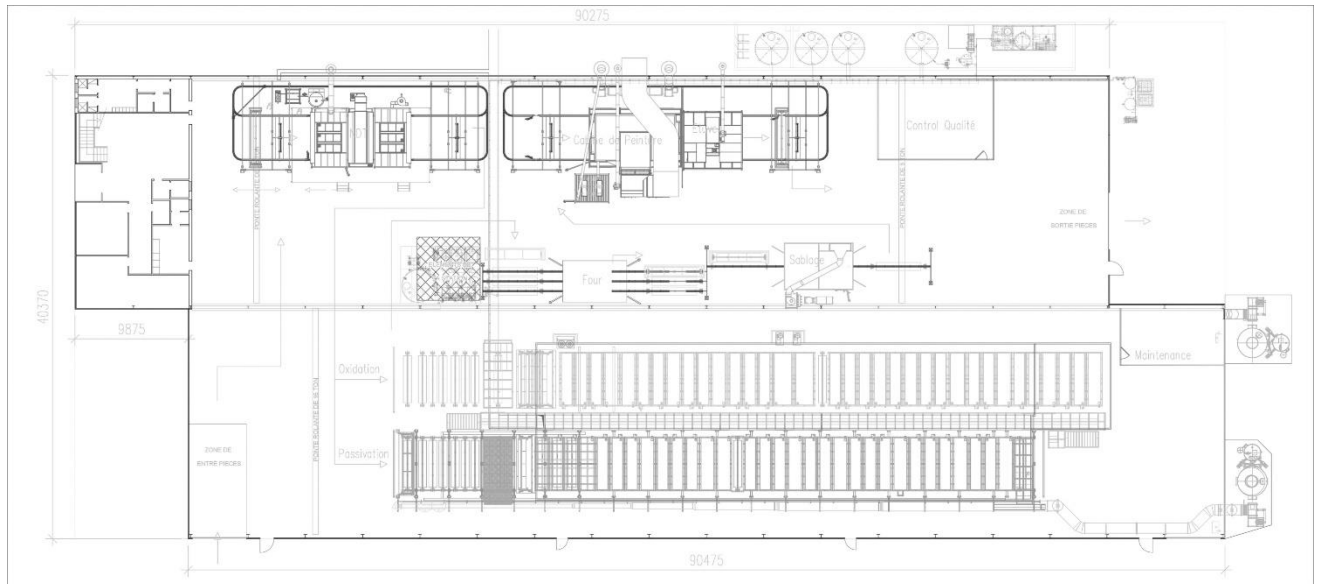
Planta de layout da unidade da SURTIP (s/escala)
